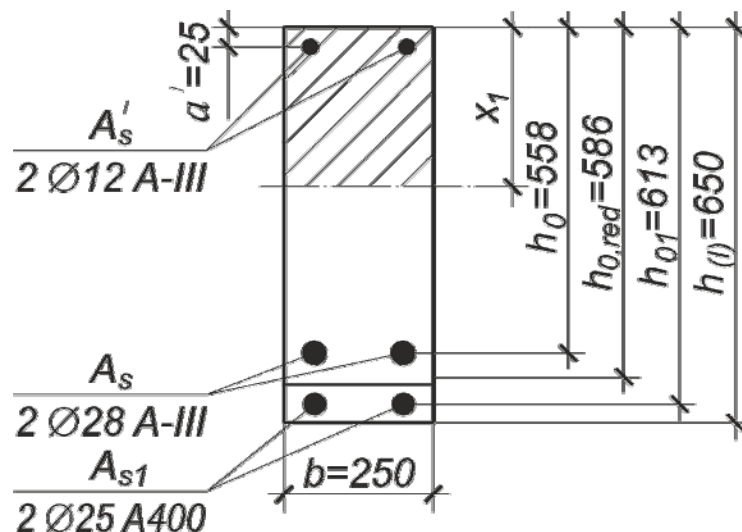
Расчетное сечение ригеля, усиленного дополнительным армированием
